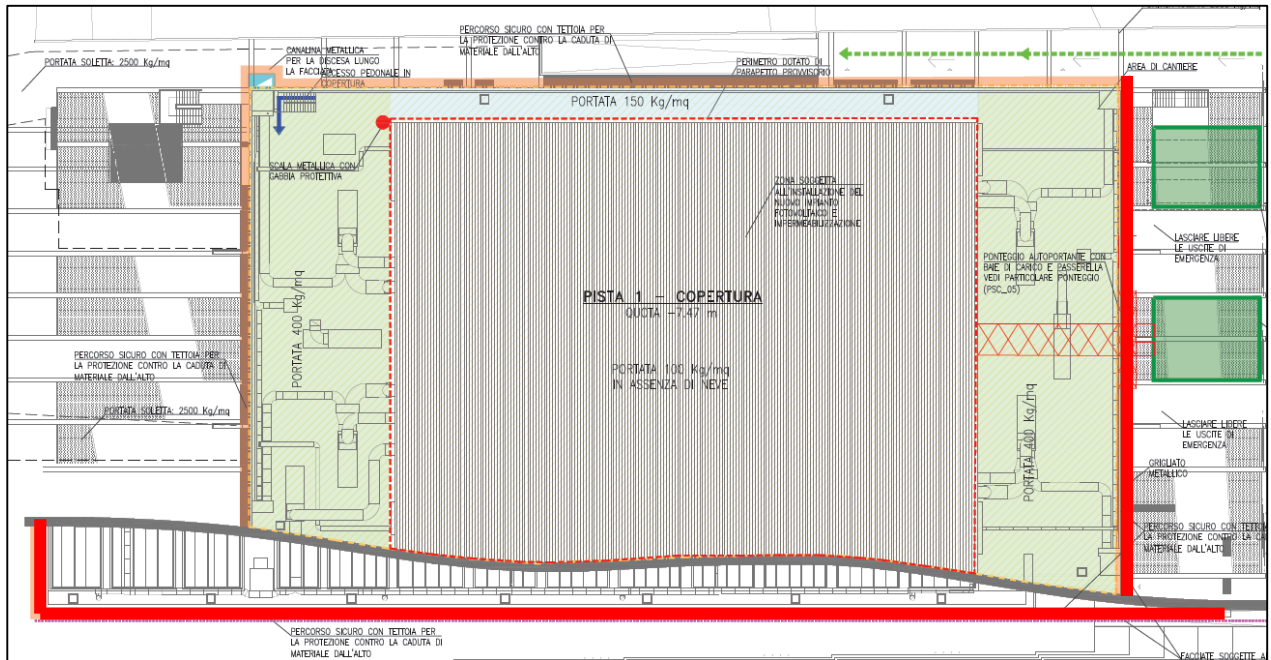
Layout con individuazione in rosso delle aree oggetto di intervento.
